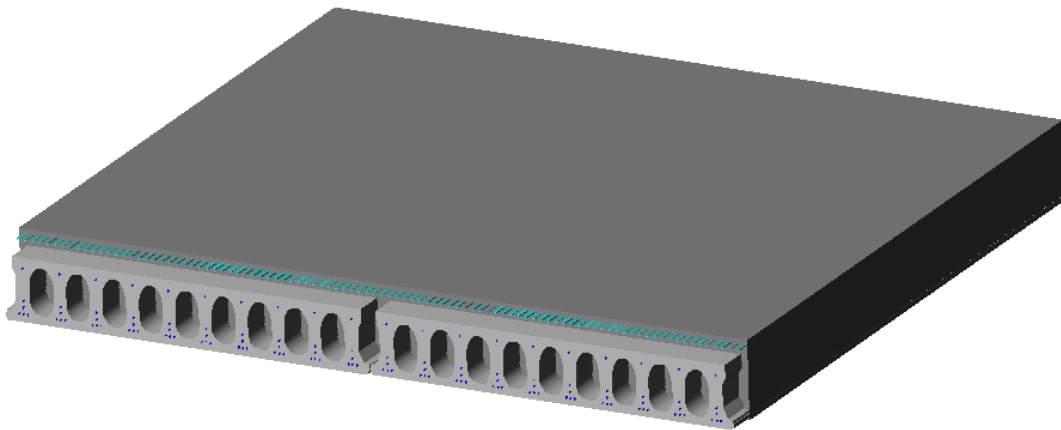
Pavimento com armadura de distribuição e lâmina de compressão.
